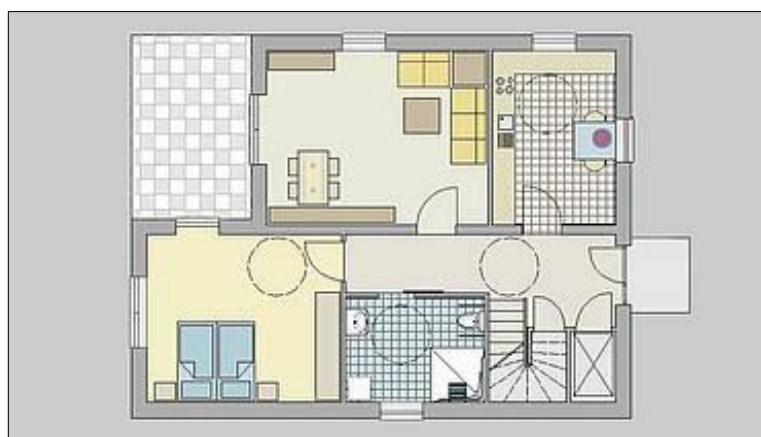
Grundriss einer barrierefreien Wohnung¹⁰
